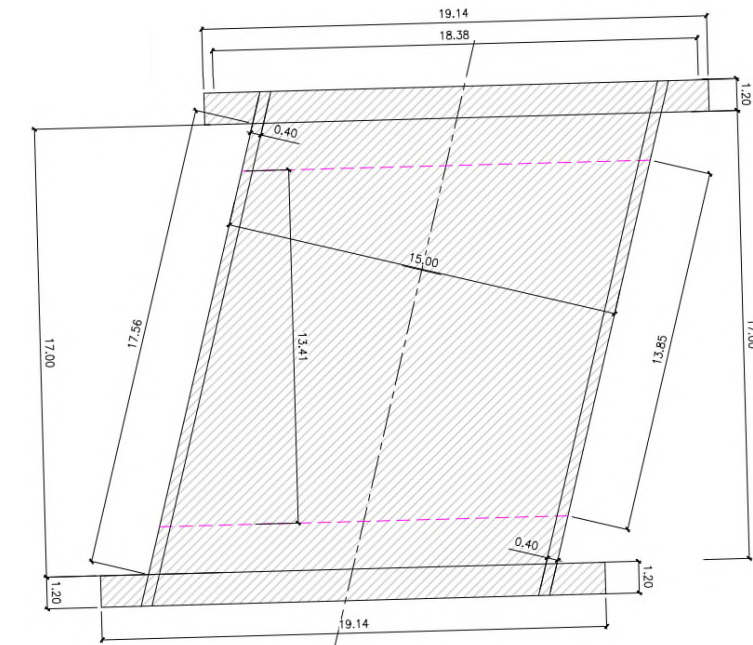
Planta del puente sobre el río Baliera (Pueyo, 2025).
